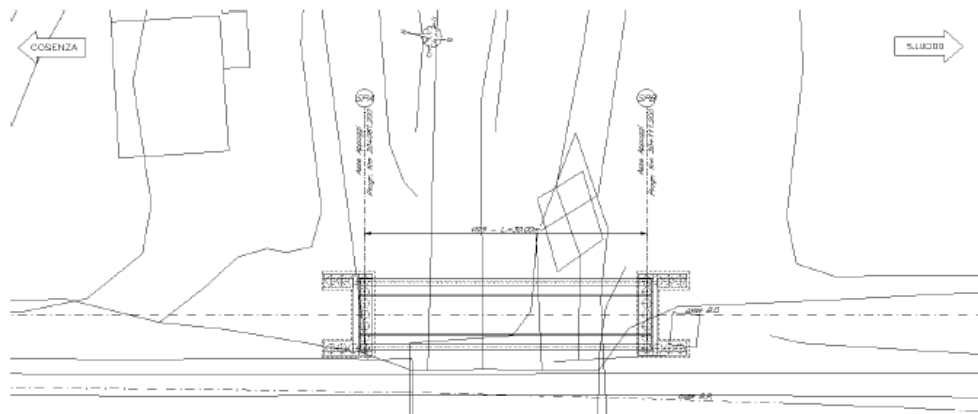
Planimetria del viadotto ferroviario VI05b
